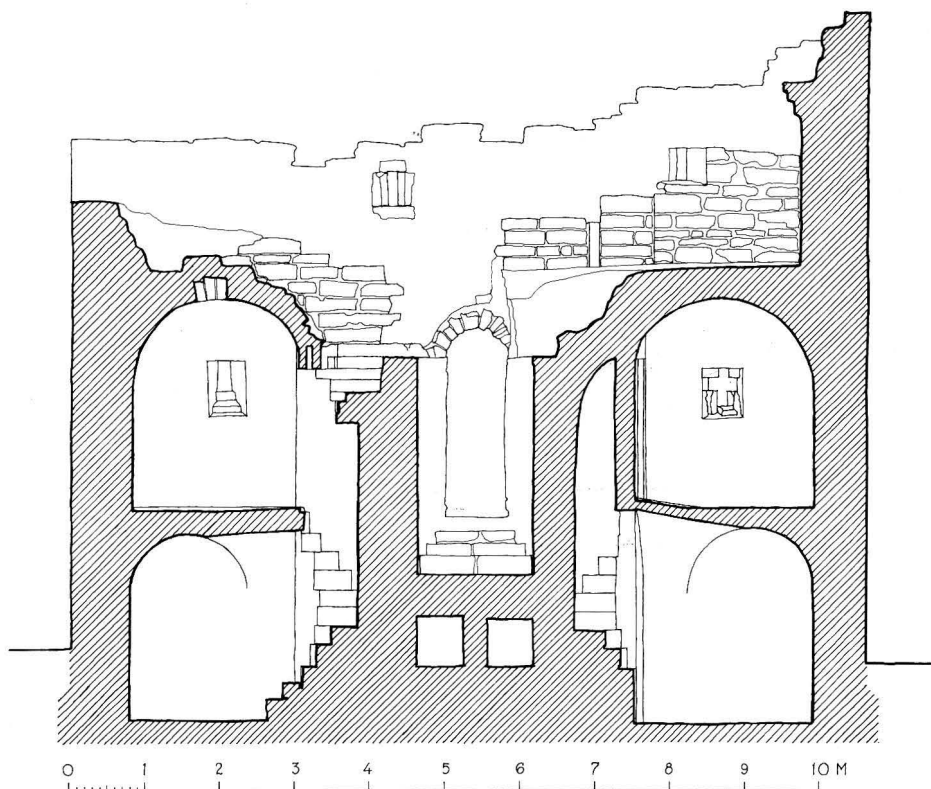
Smårummen inom korets östra del, sektion mot öster, 1:100. Uppm J Pajaujis 1978. Jfr fig 17. *Small rooms in eastern part of the chancel, E section. Scale drawing by J Pajaujis 1978.
